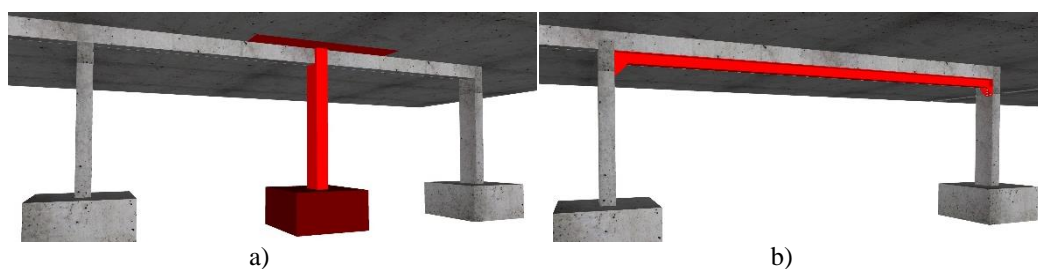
Técnicas alternativas de reforço por alteração estrutural de um vão; a) Construção de pilar incluindo a respetiva fundação e reforço da viga para momentos negativos; b) Montagem de viga metálica para reforço da viga existente [26].
